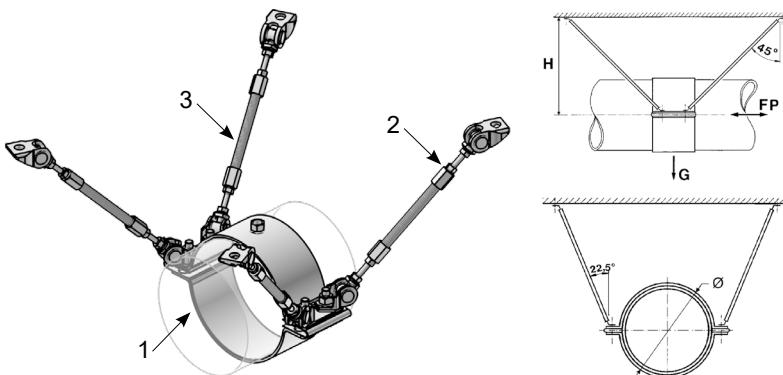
Dimensiones de montaje para Disposición en caballete
